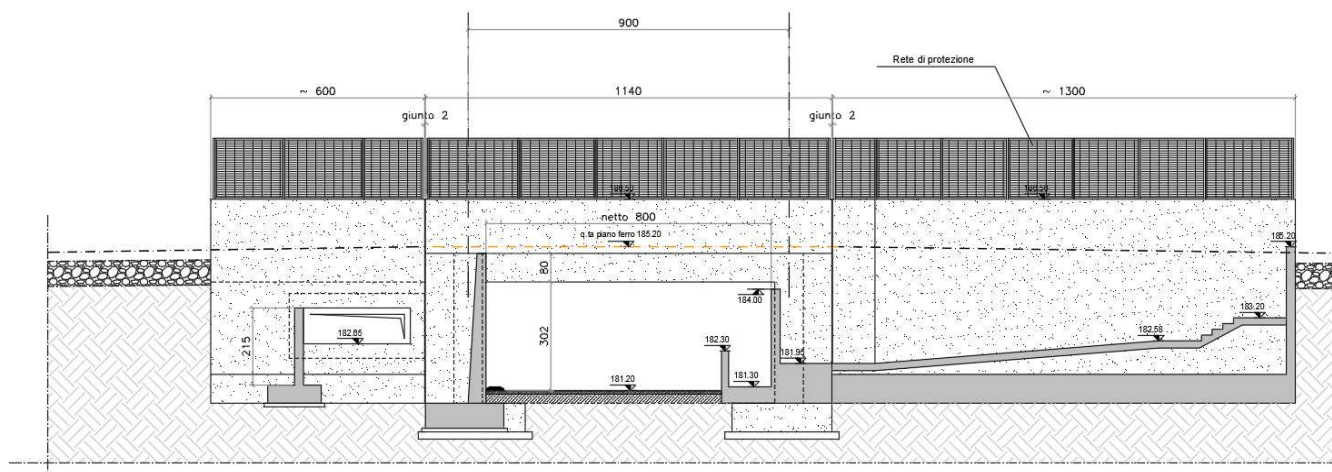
Prospetto lato ovest (filo imbocco scatolare)
